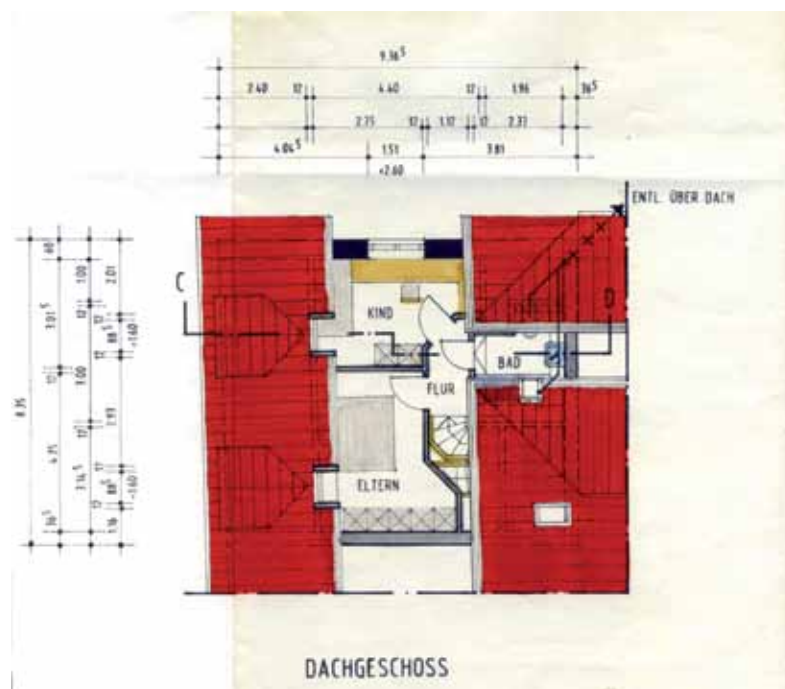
Grundriss DG (2. OG) Reihenhaushaus Wendelsheim (Quelle: FRANZEN, N.: Grundriss Reihenhaushaus (unveröffentlicht))
